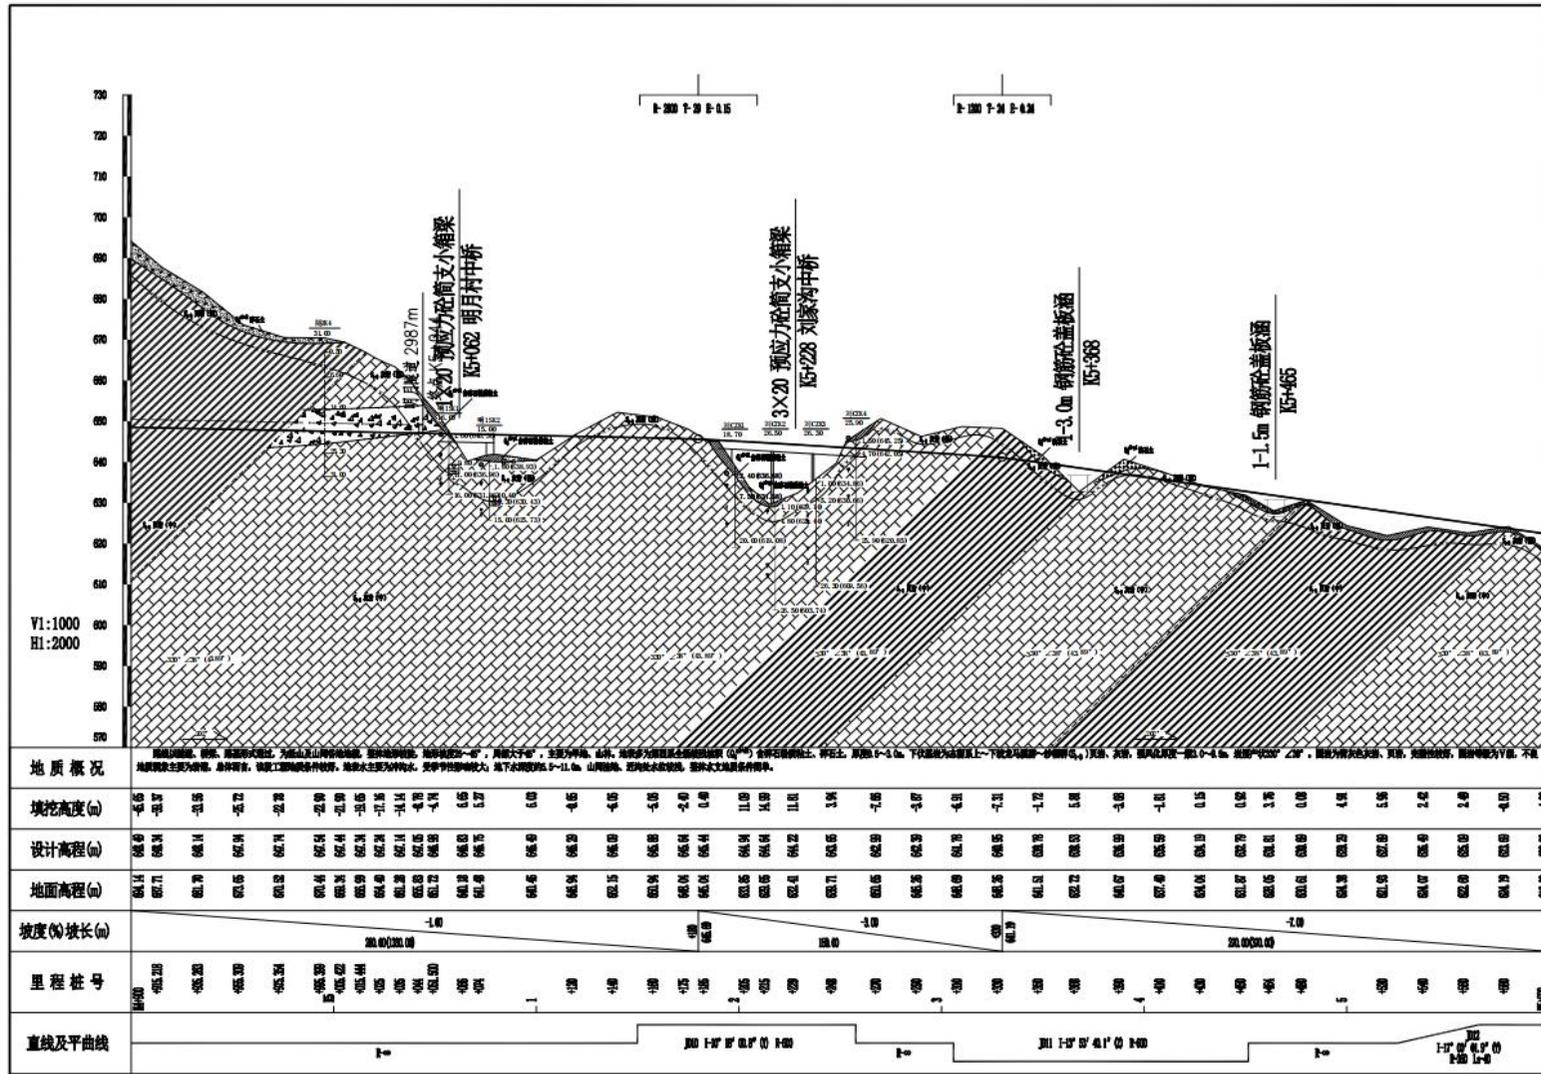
K4+900~K5+600 段路线工程地质纵断面图
